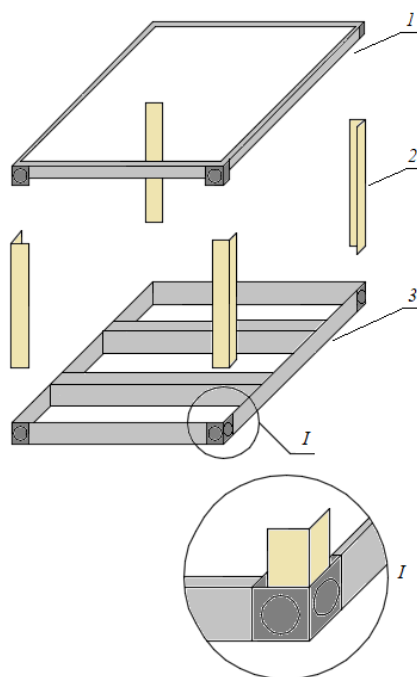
Конструкция силового каркаса КСУ: 1 – верхний пояс; 2 – вертикальные связи; 3 – нижний пояс, усиленный промежуточными поперечными балками; I – элемент строповки
